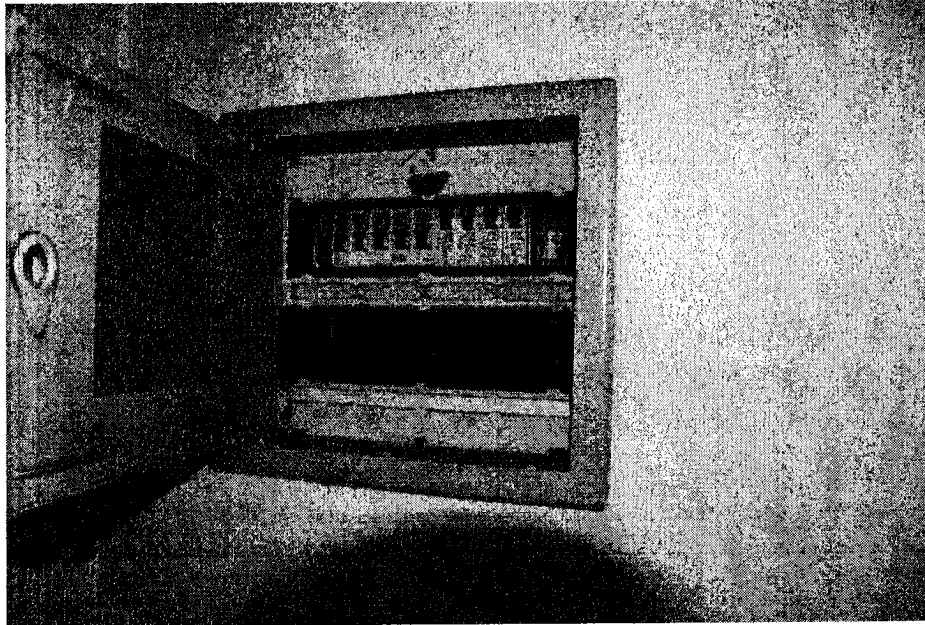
Erdgeschoss, Stromverteilerkasten, nicht auf dem aktuellen Stand der Technik
